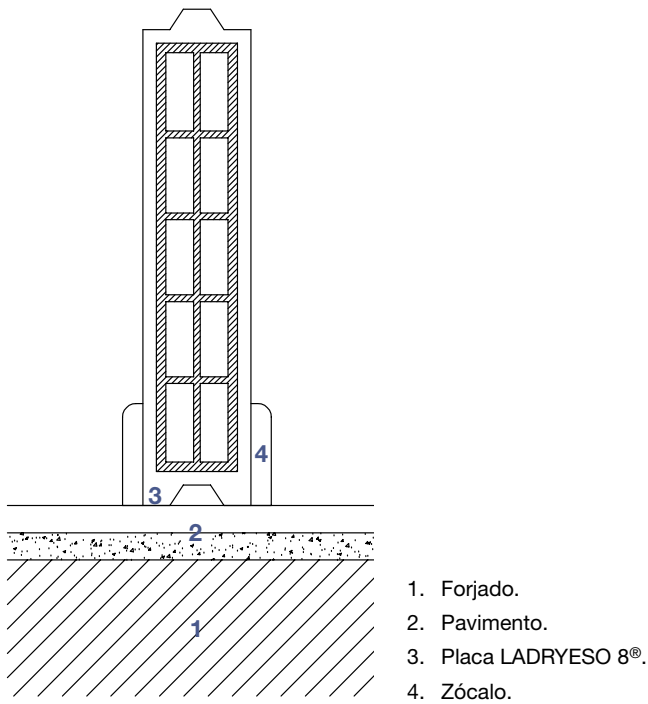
Colocación del tabique LADRYESO 8® sobre pavimento.
